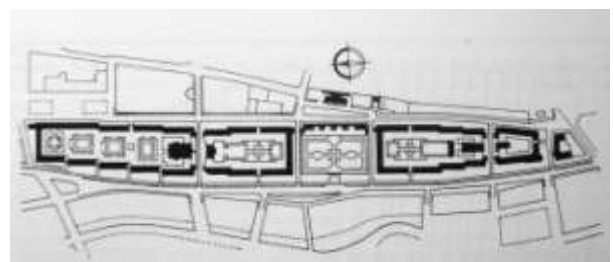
Karl-Marx-Hof, Viena, planta.
